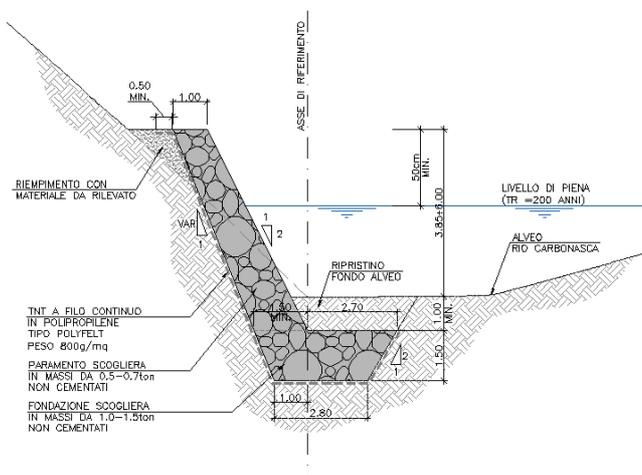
Sezione tipologica scogliera – Tratto in sponda sinistra
